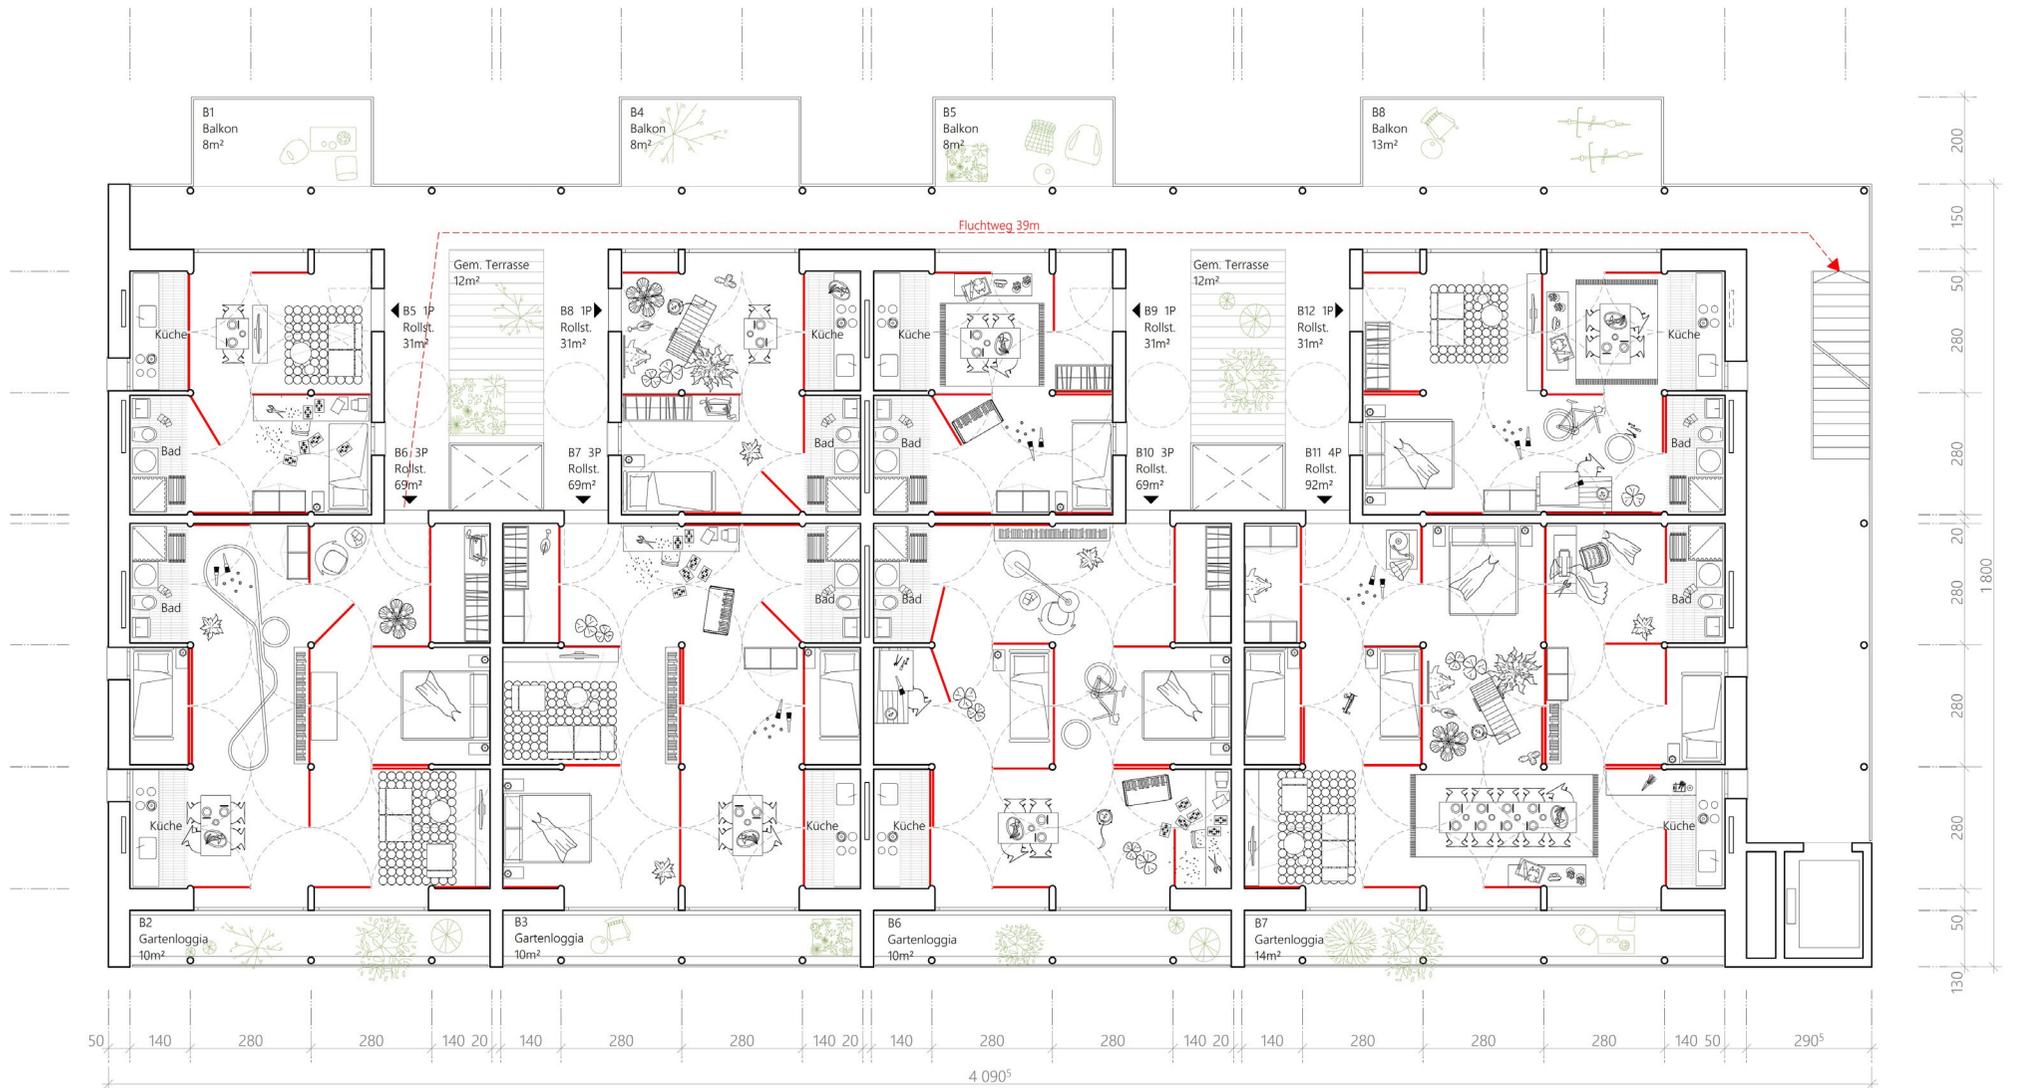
Regelgeschoss | M 1:175 | Studio Robertha (Wien)
